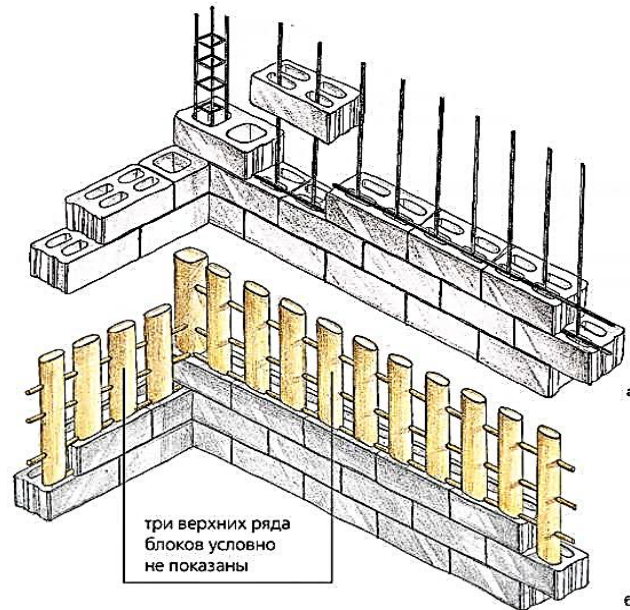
Монолітно-бетонна решітка каркаса: а – опалубка з полістиролбетону; б – утворення монолітної залізобетонної решітки
